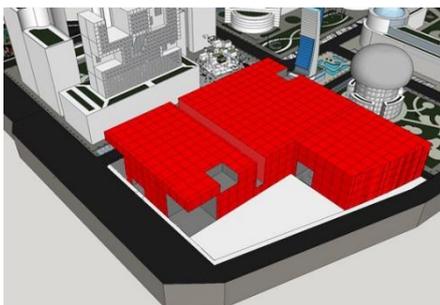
Fissuration pour l'accessibilité solaire et air
